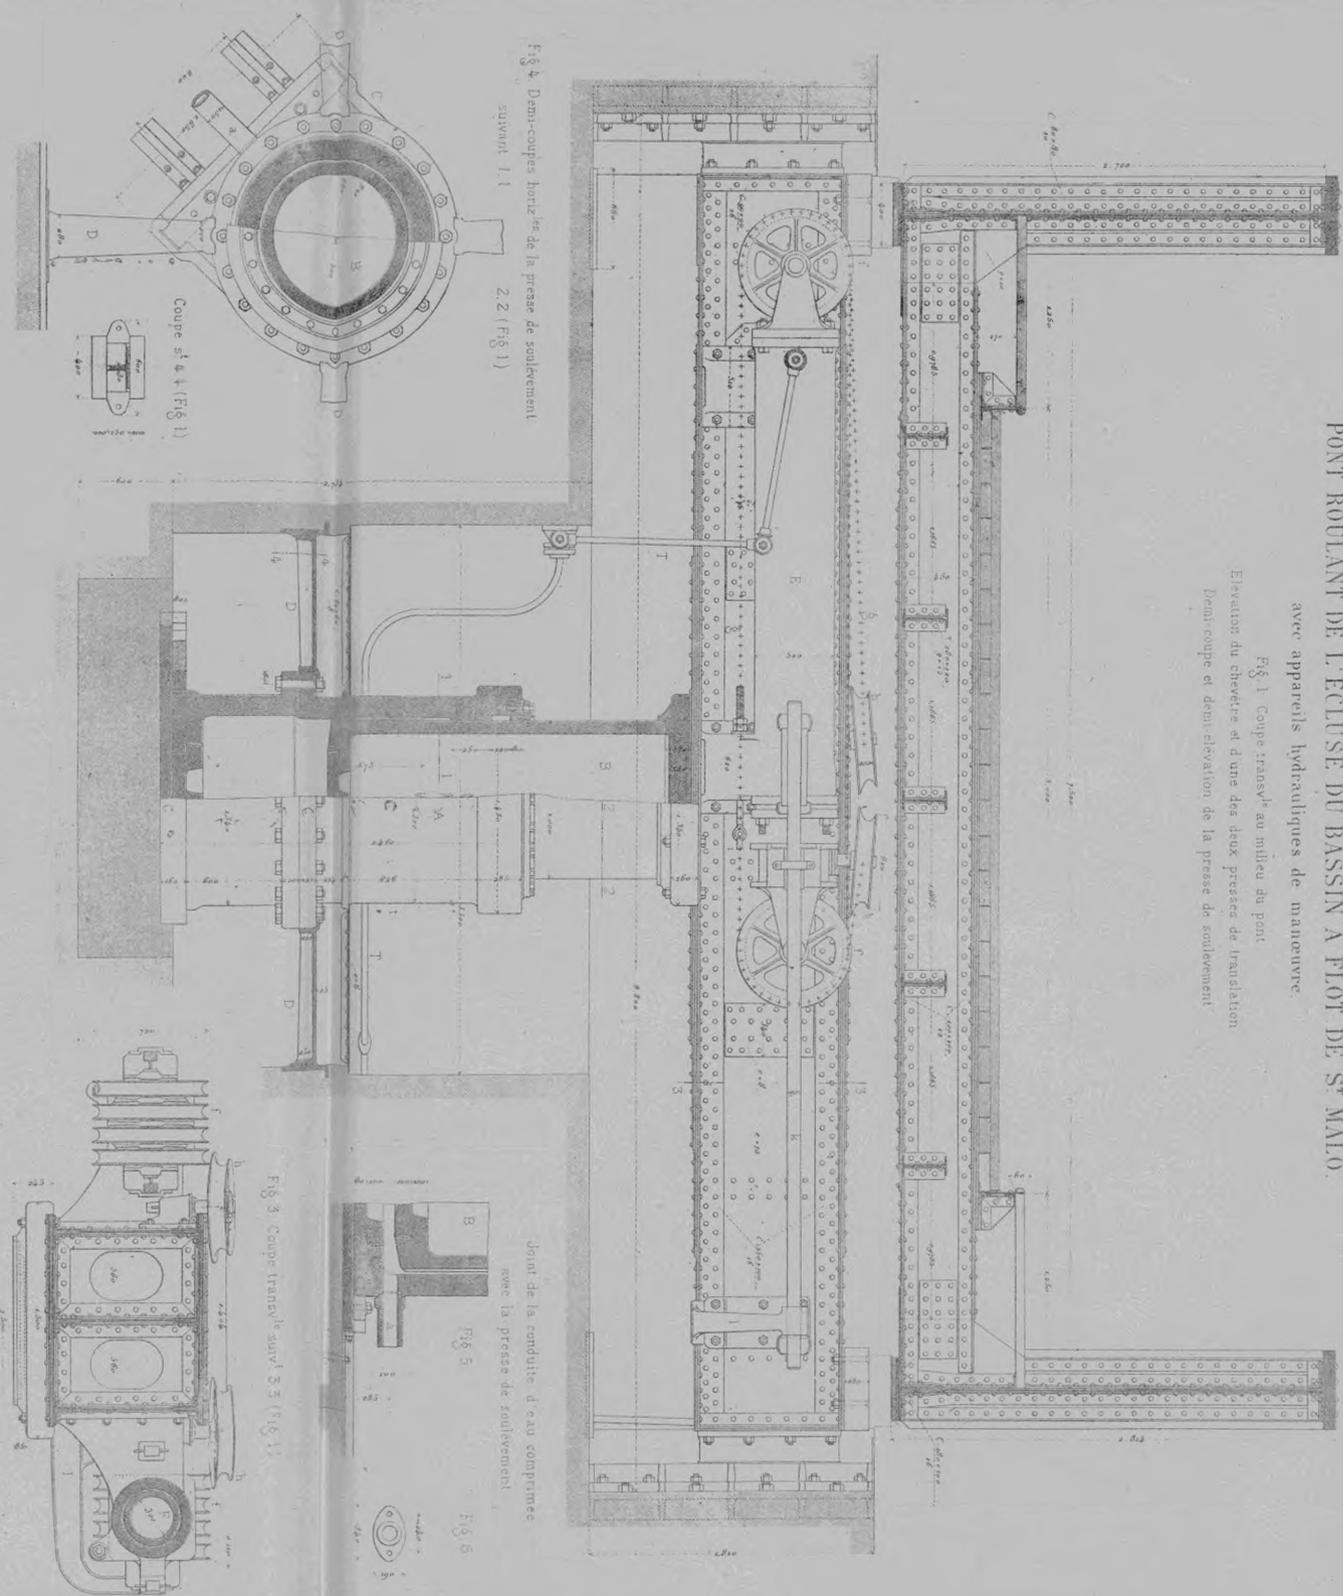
Coupe horizontale et plan du chevrete avec les presses de translation
